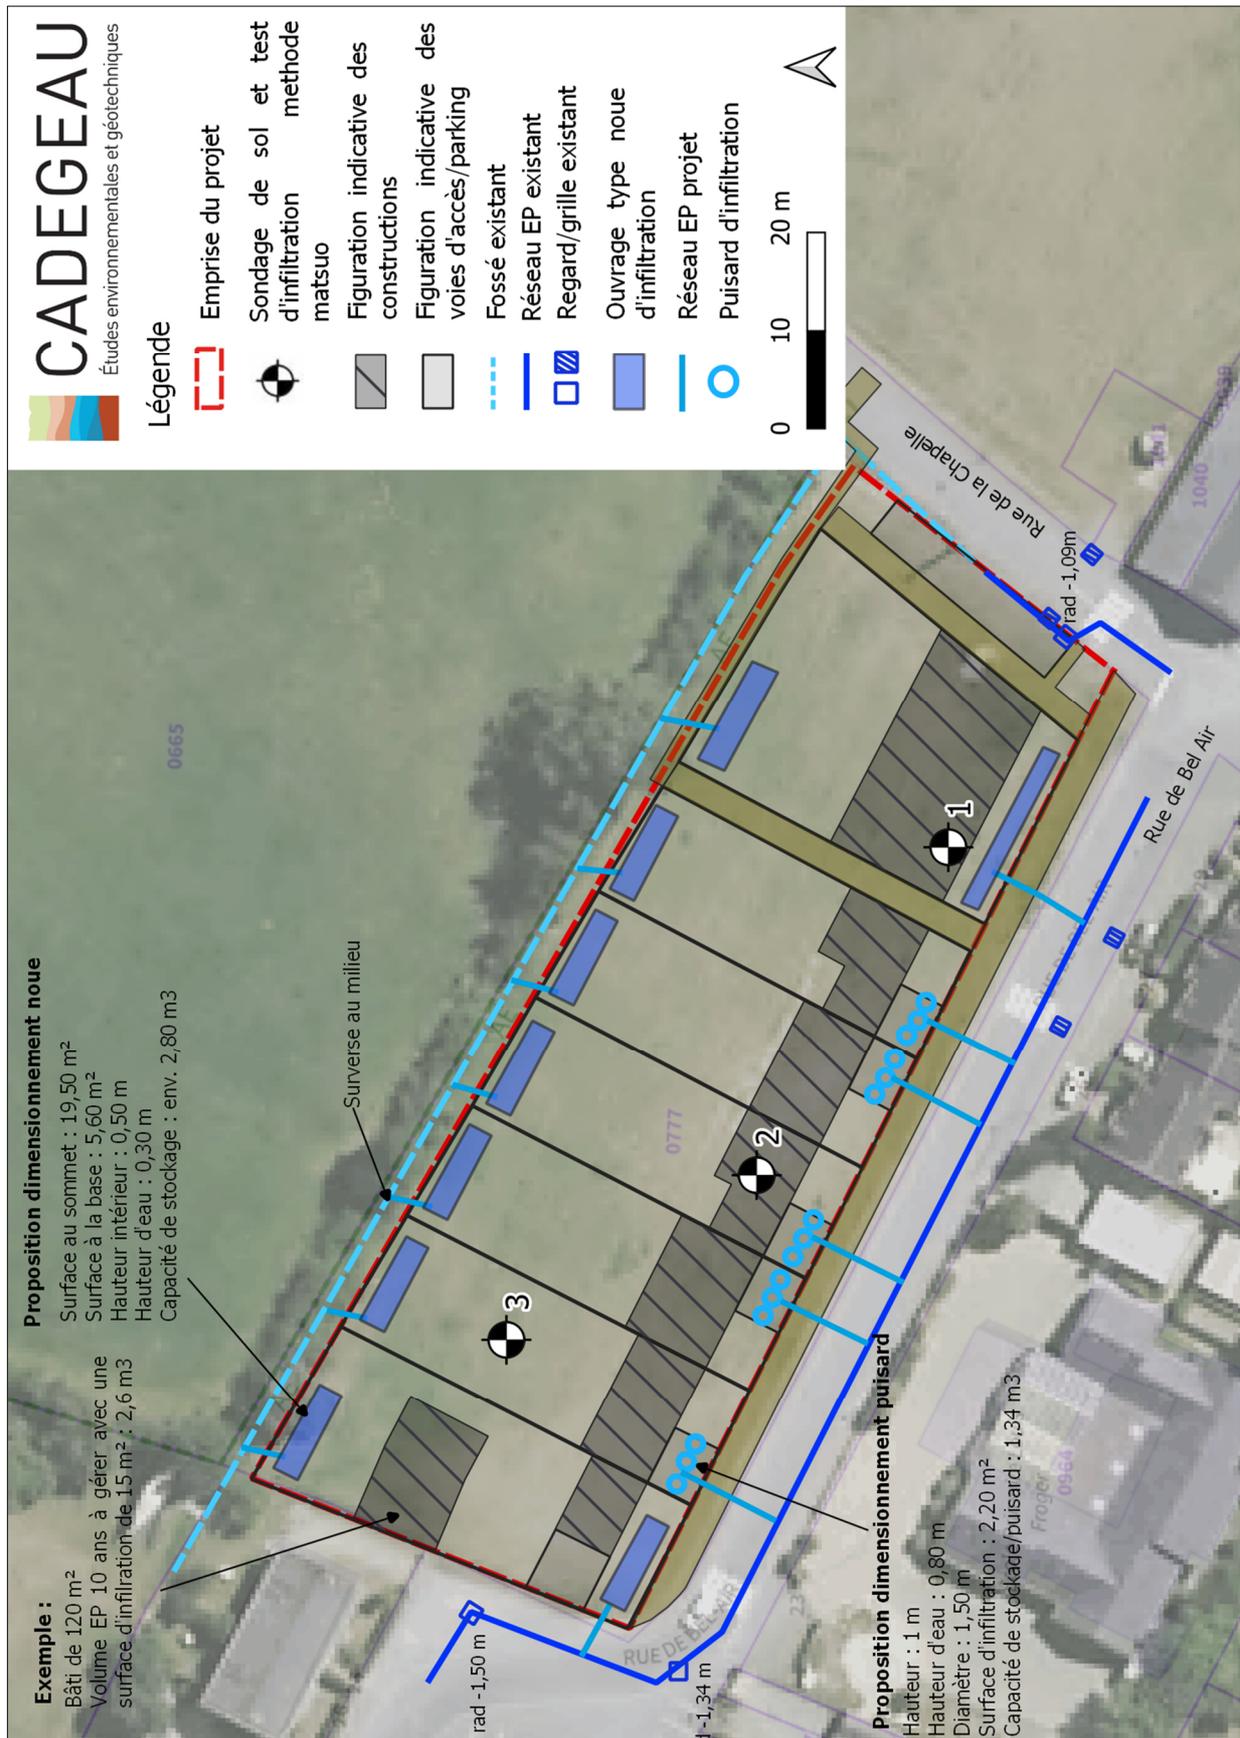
Plan du dispositif d'assainissement des eaux pluviales
